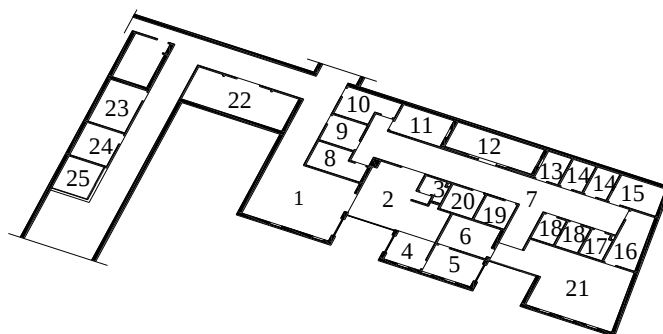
| Planta esquemática do Piso – 1, Fisioterapia.
